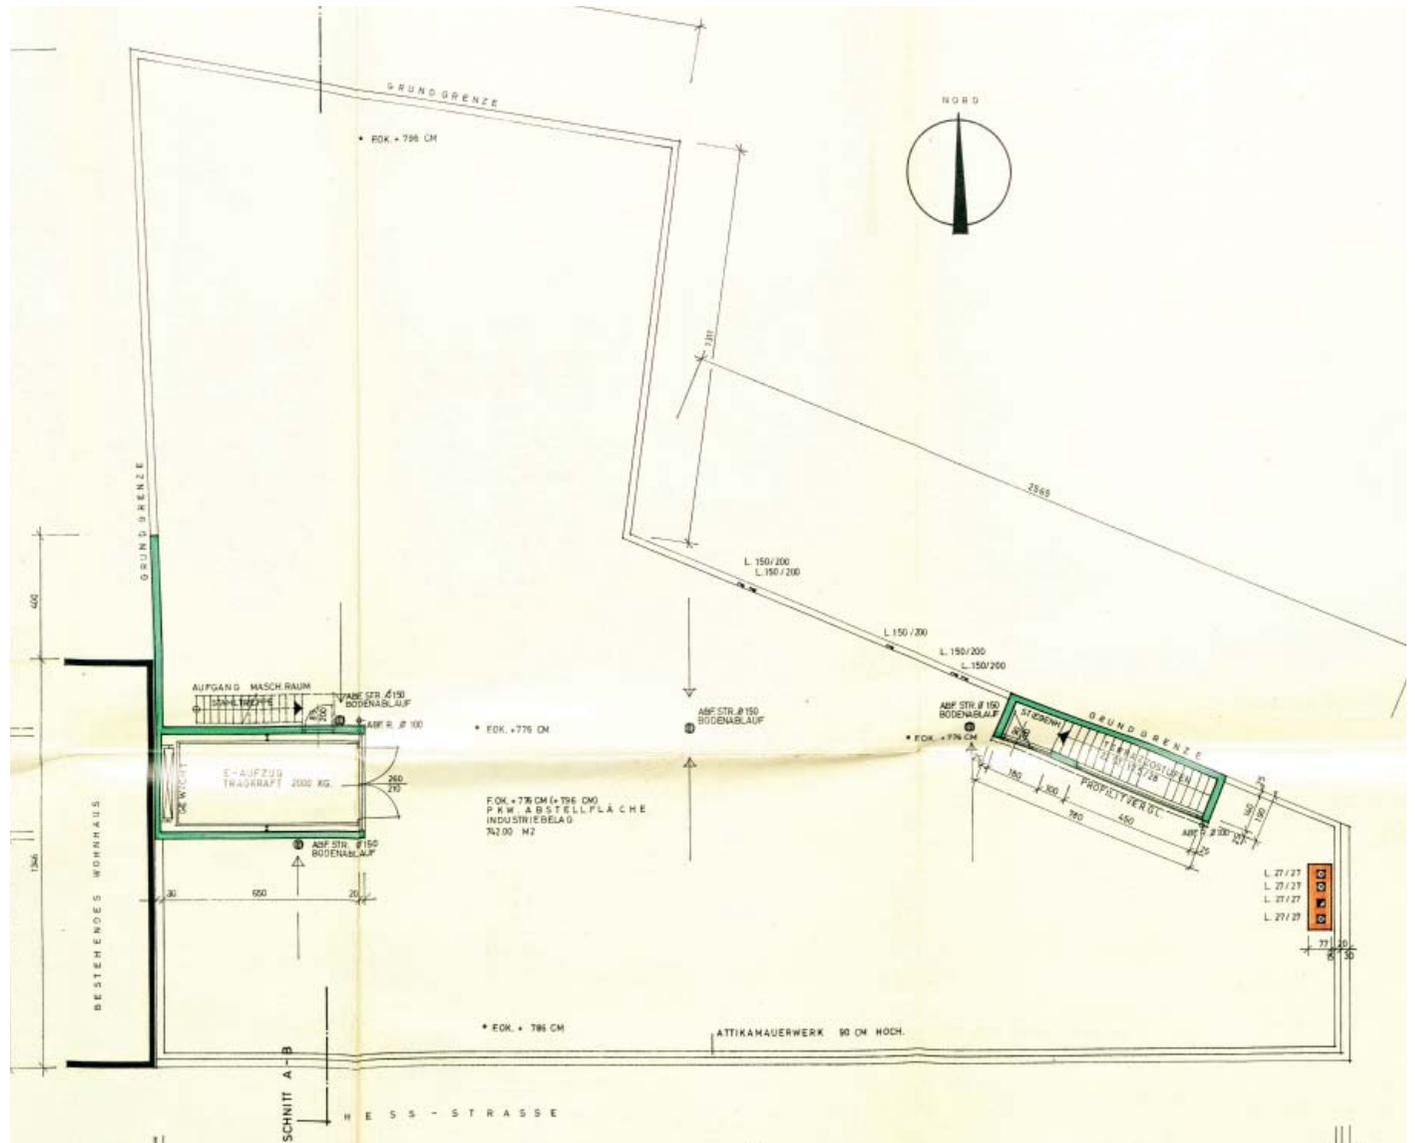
Auswechslungsplan, Dachgeschoss, 1969
